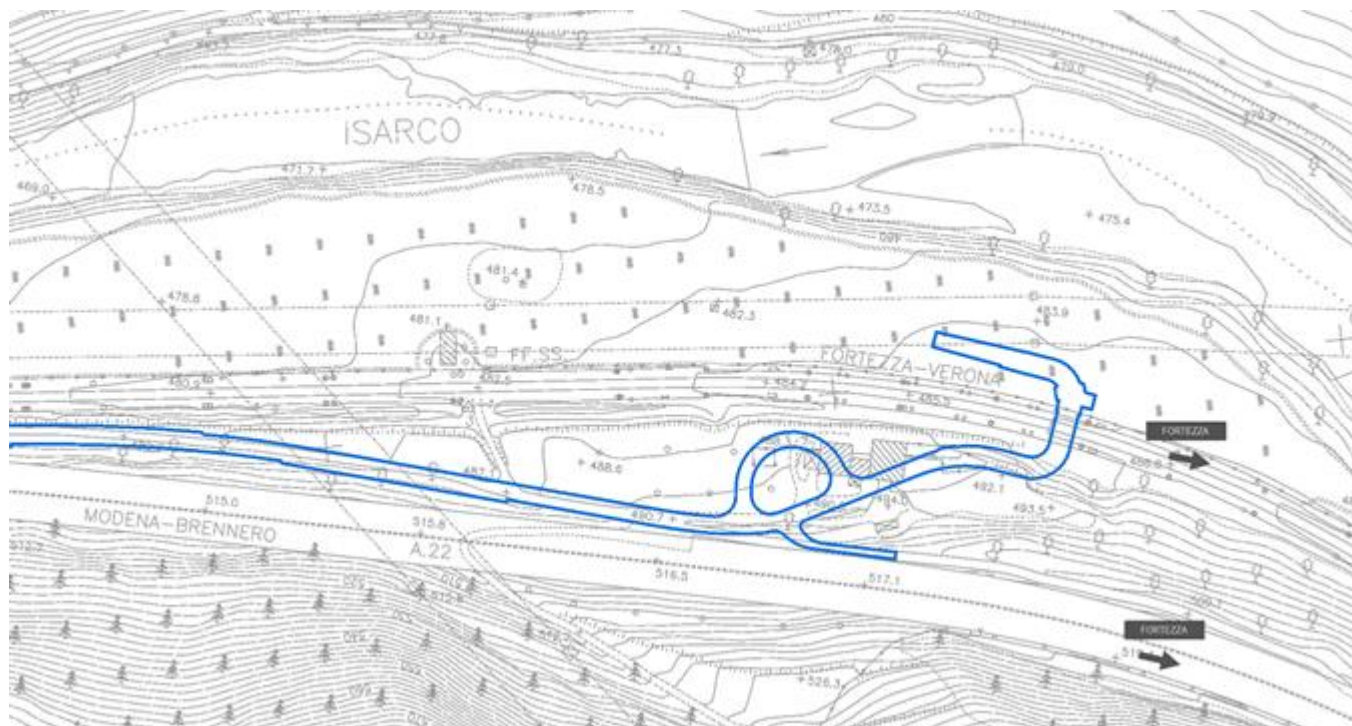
Planimetria di progetto (tra le progressive 0+575.00 m e 1+92.44 m)
